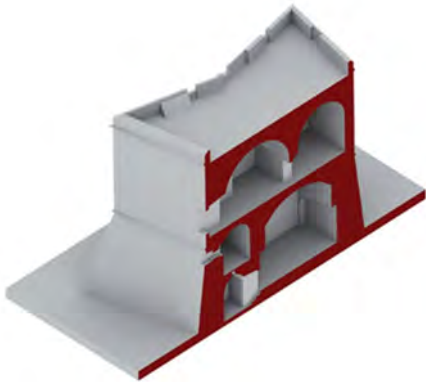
Torre di S. Pietro in Bevagna. Ipotesi sezione assonometrica del complesso nel XIX secolo.
